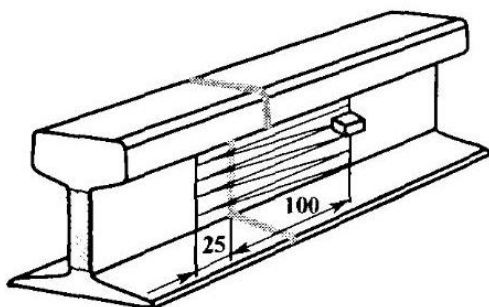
Схема прозвучивания шейки рельса сбоку в зоне сварного стыка.
